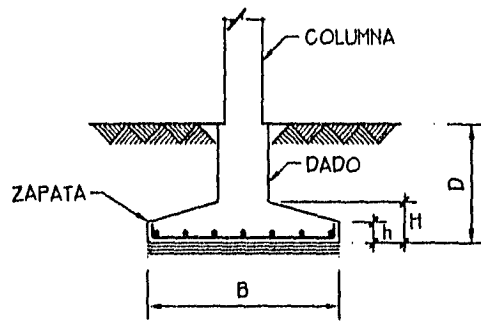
ZAPATAS AISLADAS (REF. 7)
